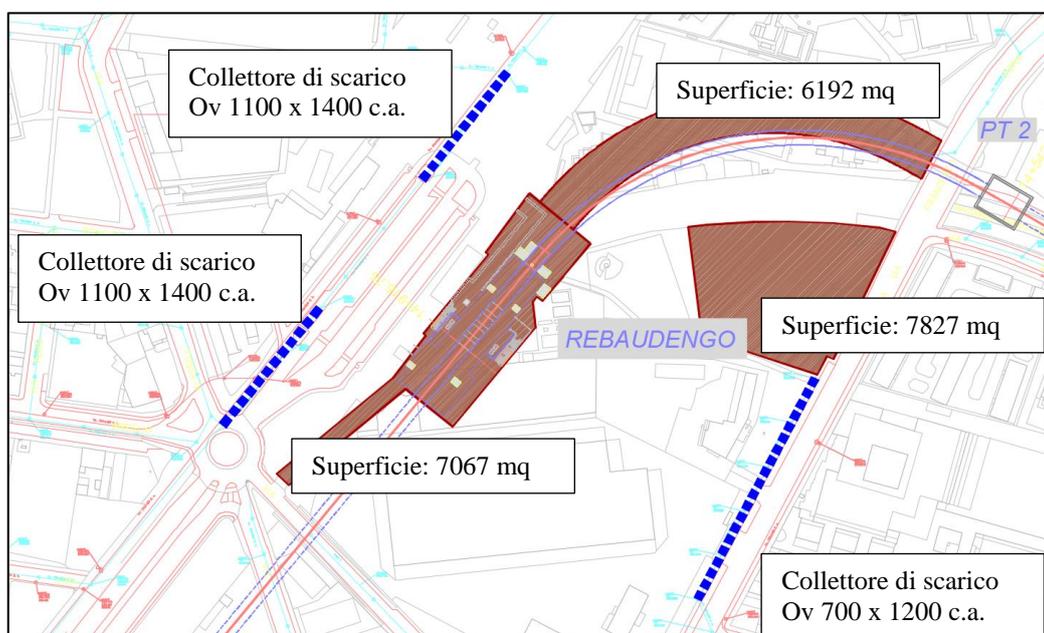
Aree di cantiere – Stazione Rebaudengo – UNICA FASE
